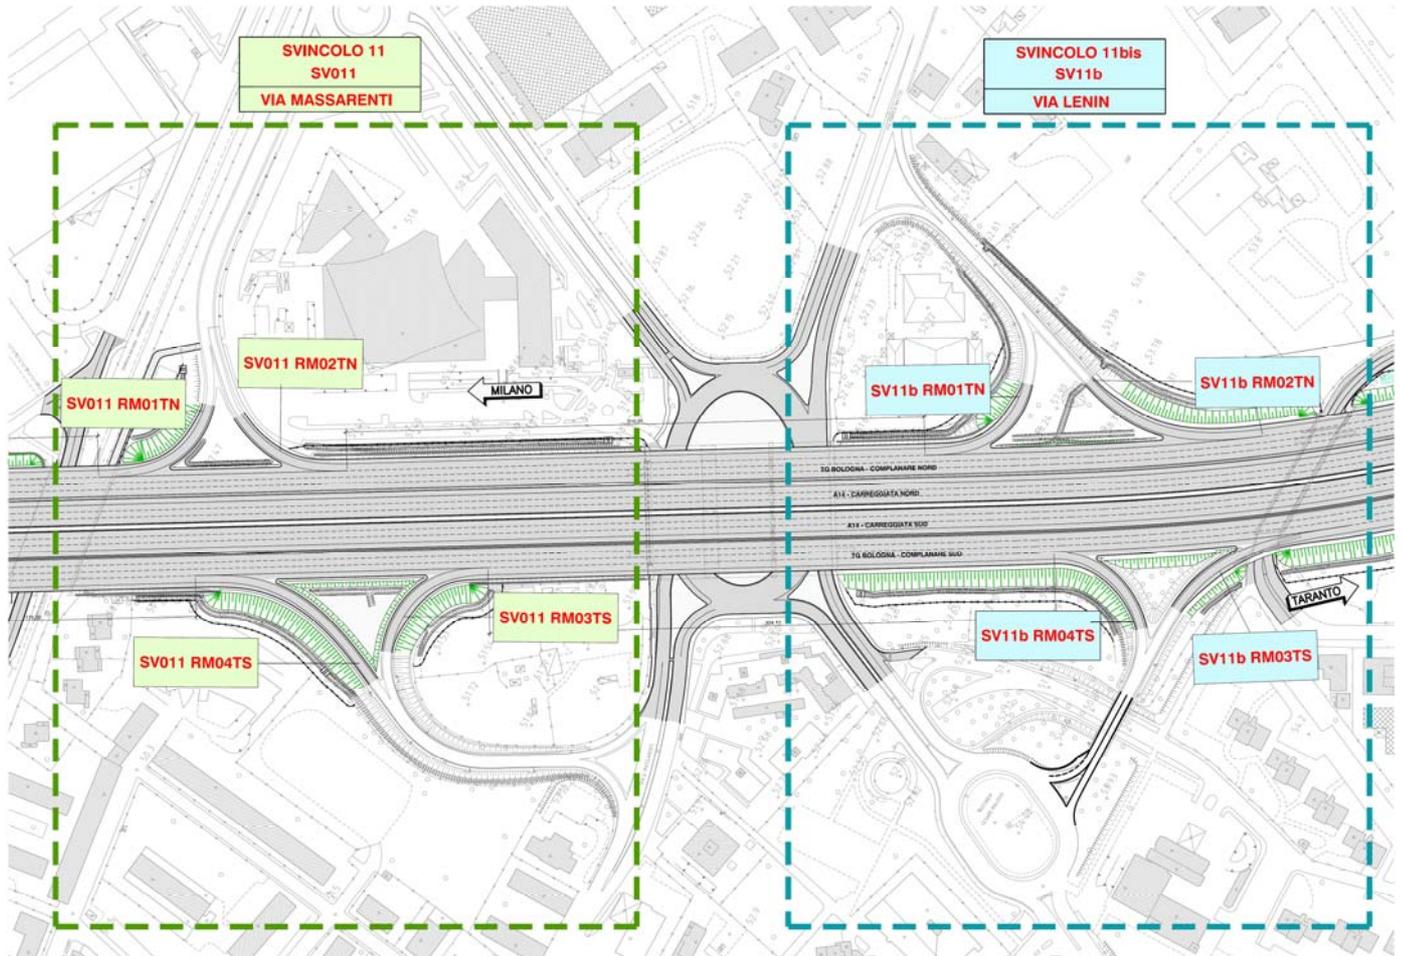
Stralcio planimetrico svincolo n.11 e 11 bis
